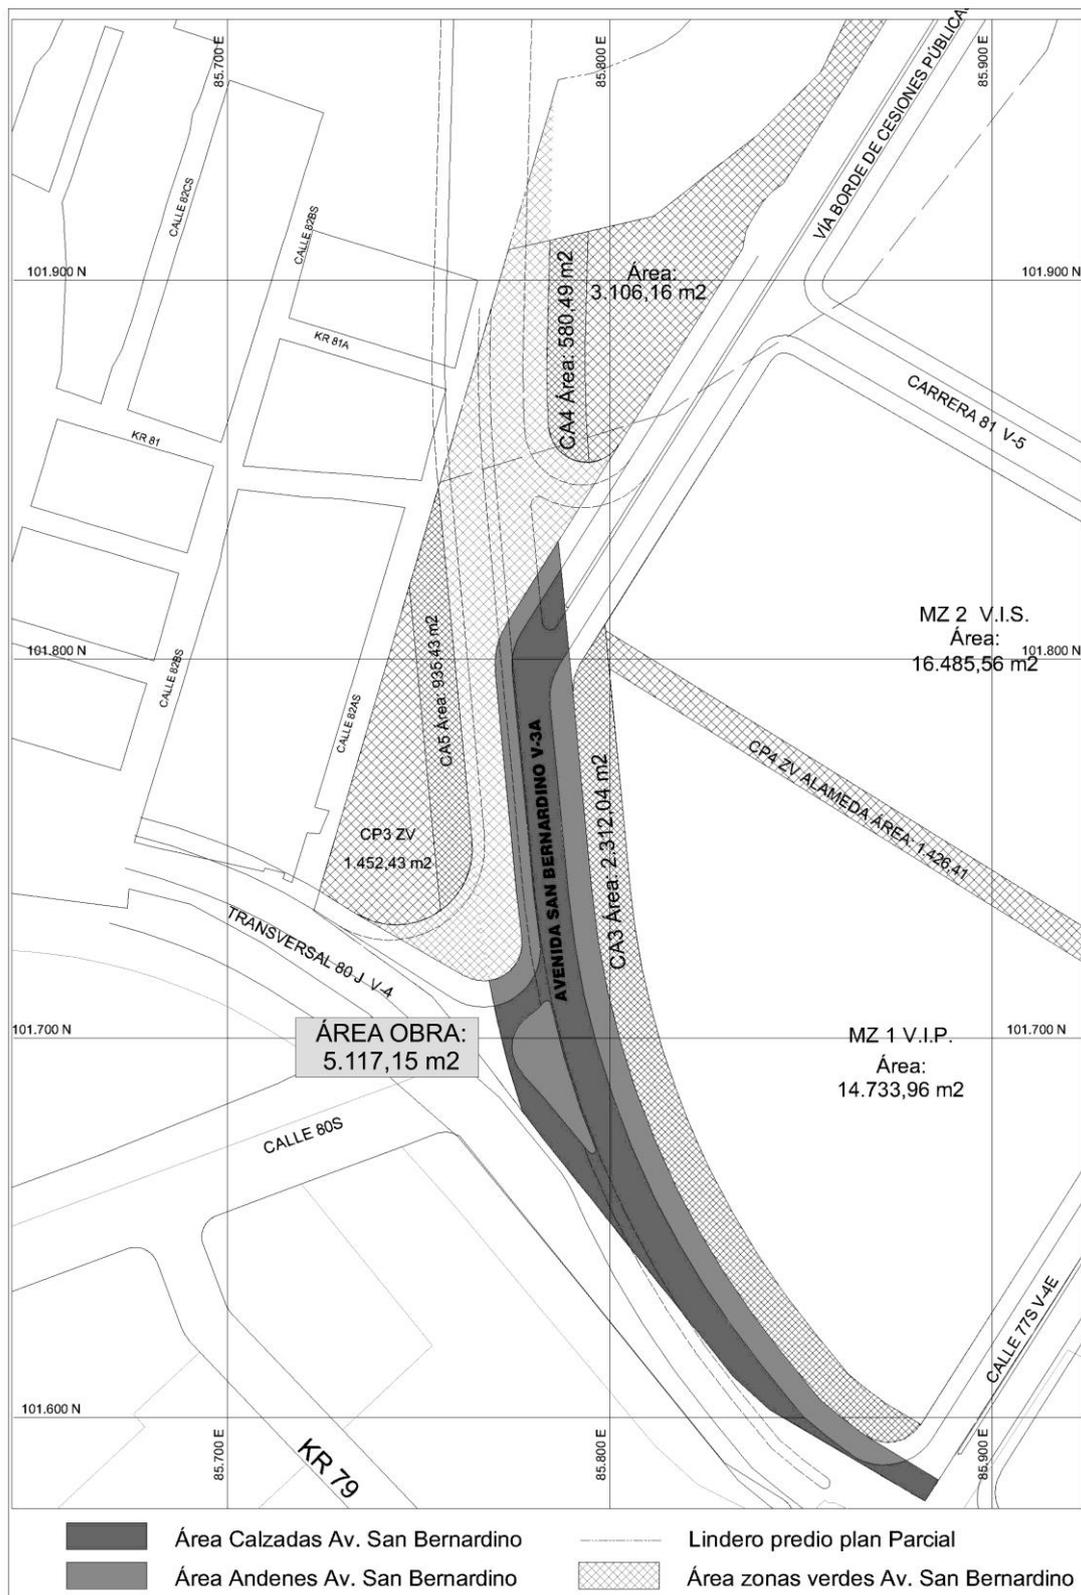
Detalle de la calzada norte de la Avenida San Bernardino, que construirá el urbanizador responsable
